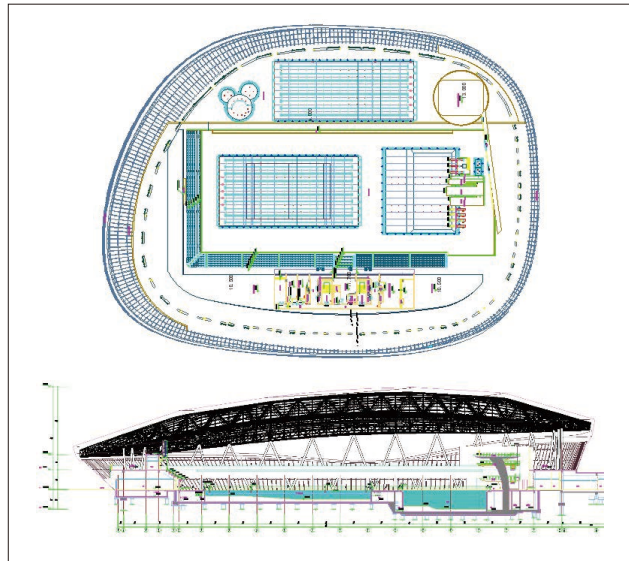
游泳馆平面图 (图片来源: 项目建筑图纸)
